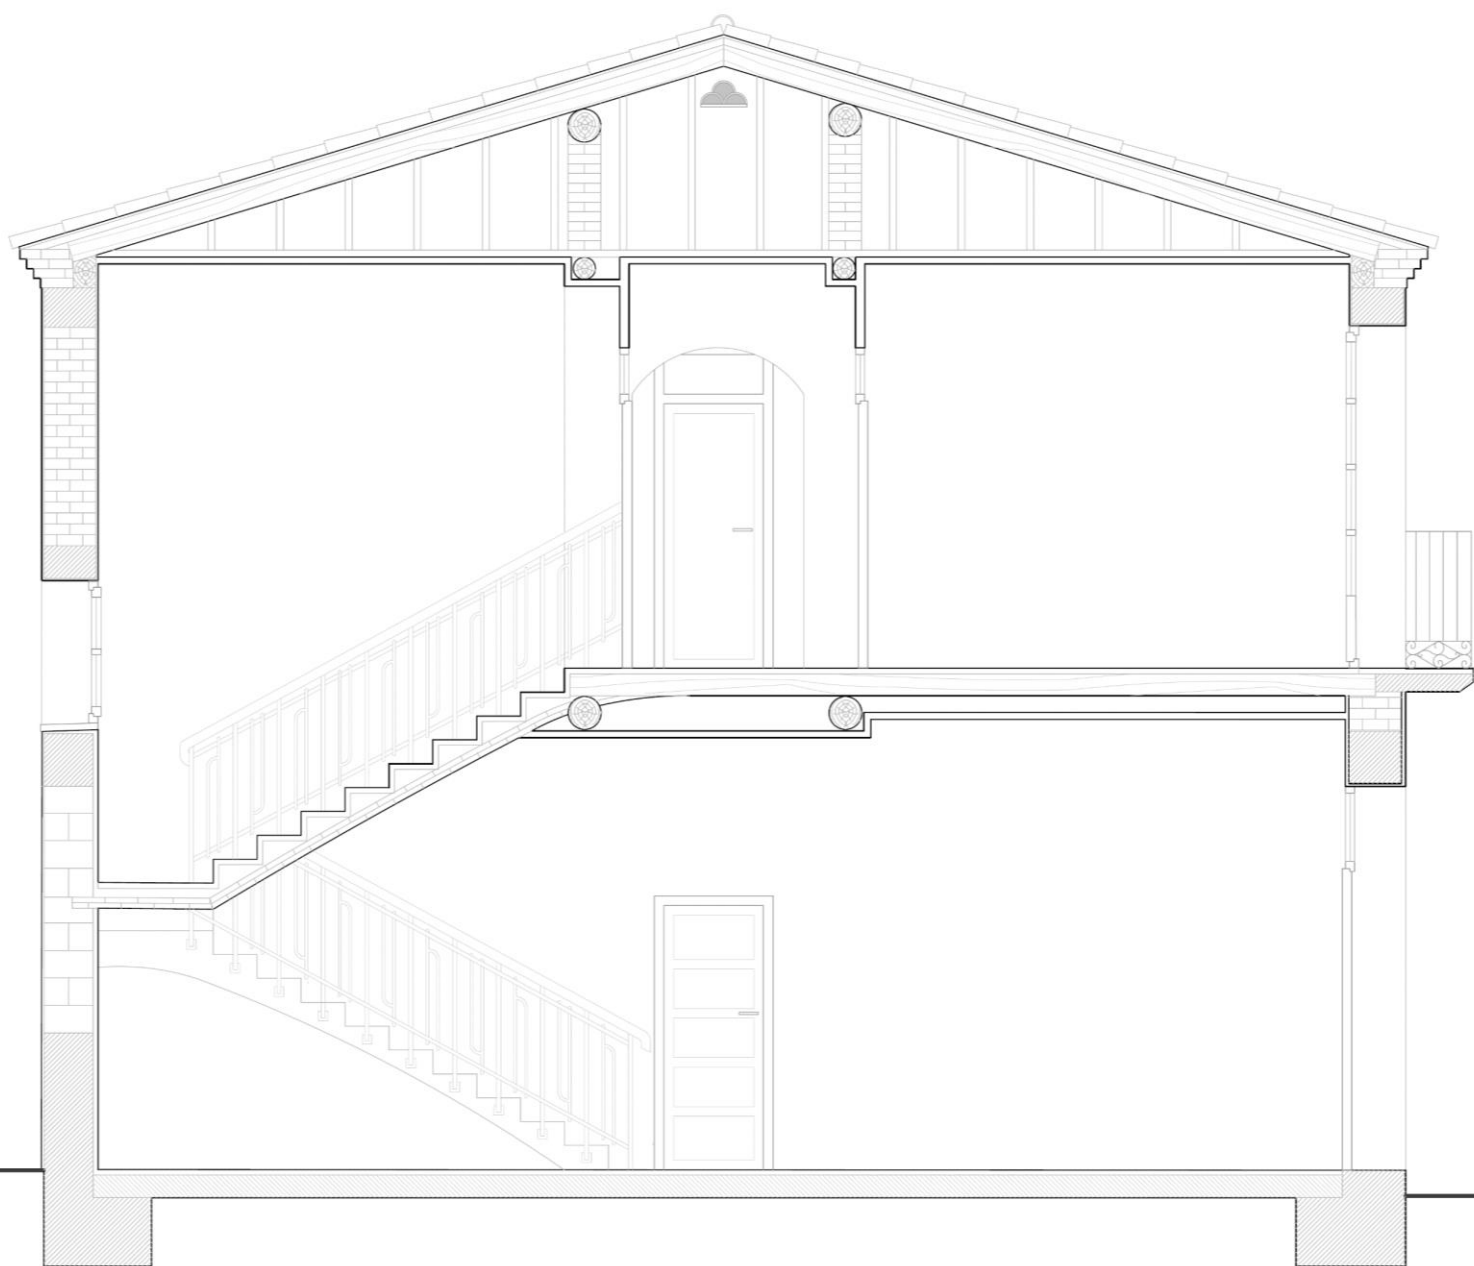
Sección constructiva 2. Fuente: Elaboración propia.
